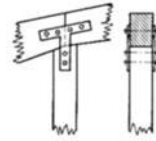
Verbindung eines Pfostens mit einem einteiligen Kranzholz in einem Lehrgerüst.
